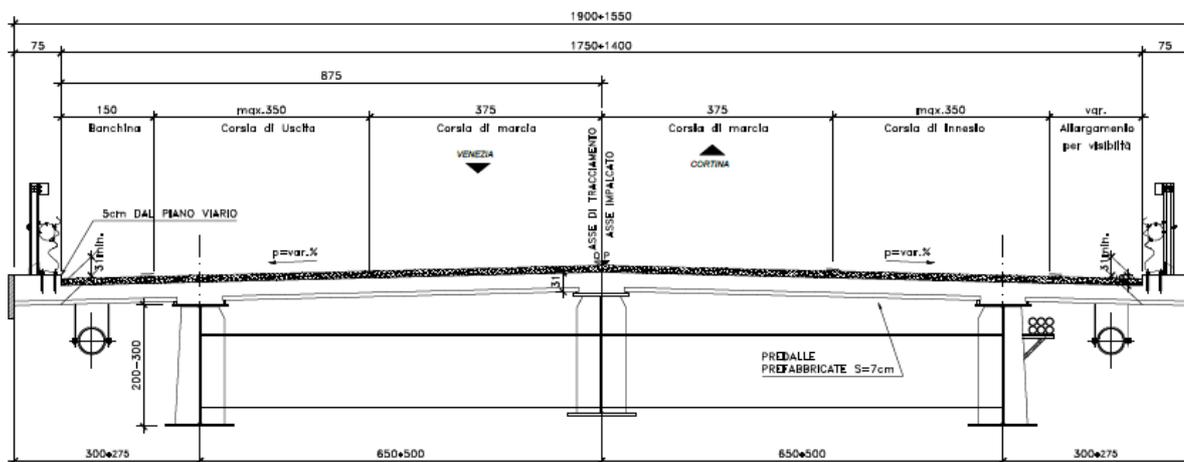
Sezione trasversale impalcato tra pila SPA e spalla P2.
